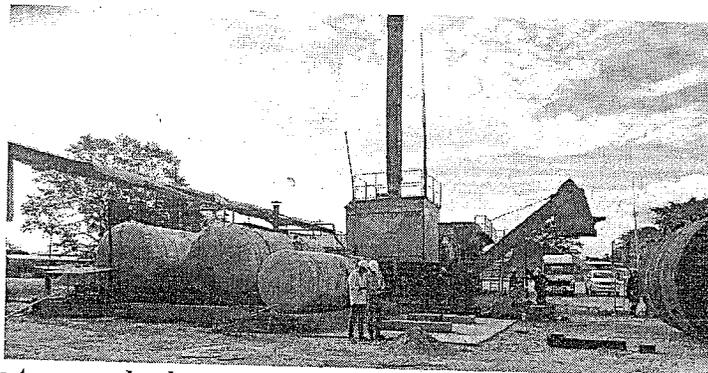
Vista tanques de almacenamiento de materia prima para la mezcla asfáltica, dispuestos en un área con piso duro en concreto, diques perimetrales construidos en mampostería (ladrillo, arena, cemento)
